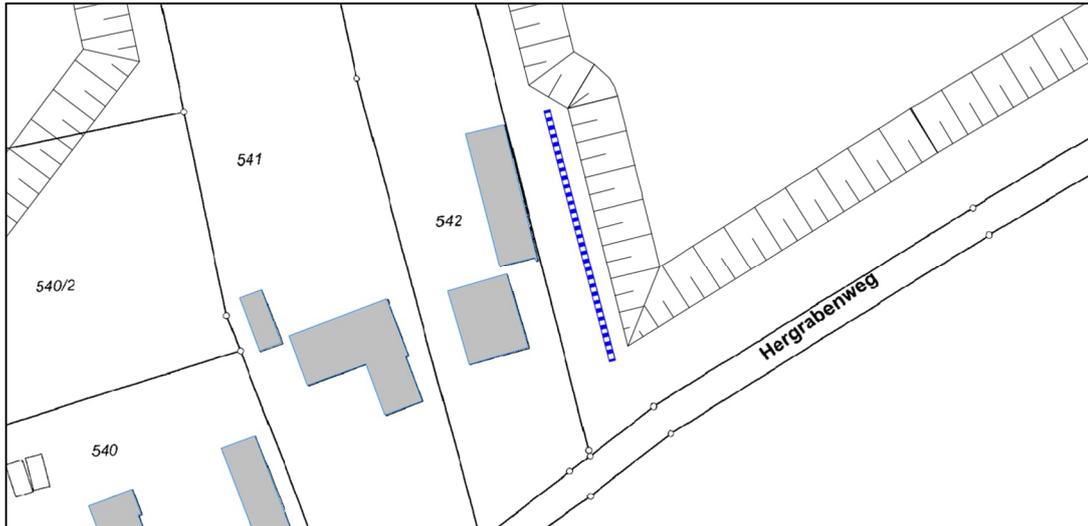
Lageplan mit Darstellung des notwendigen Lärmschutzwalls
